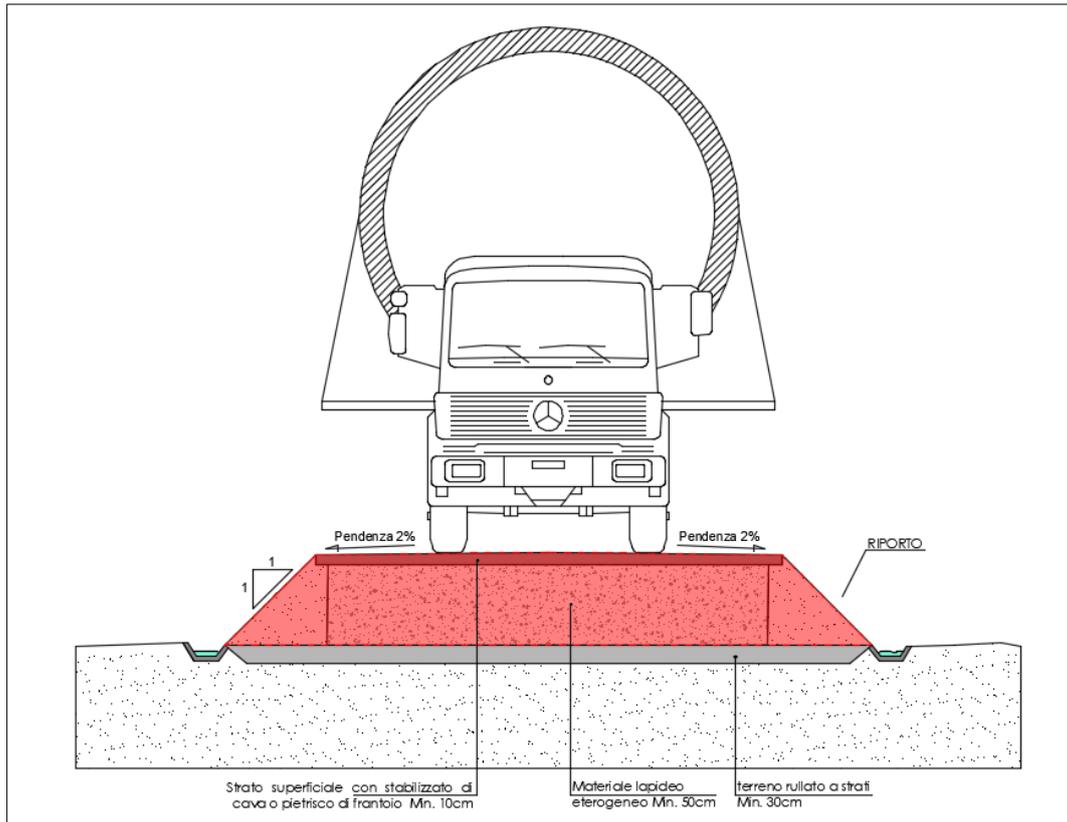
Sezione stradale tipo di nuova realizzazione in rilevato
